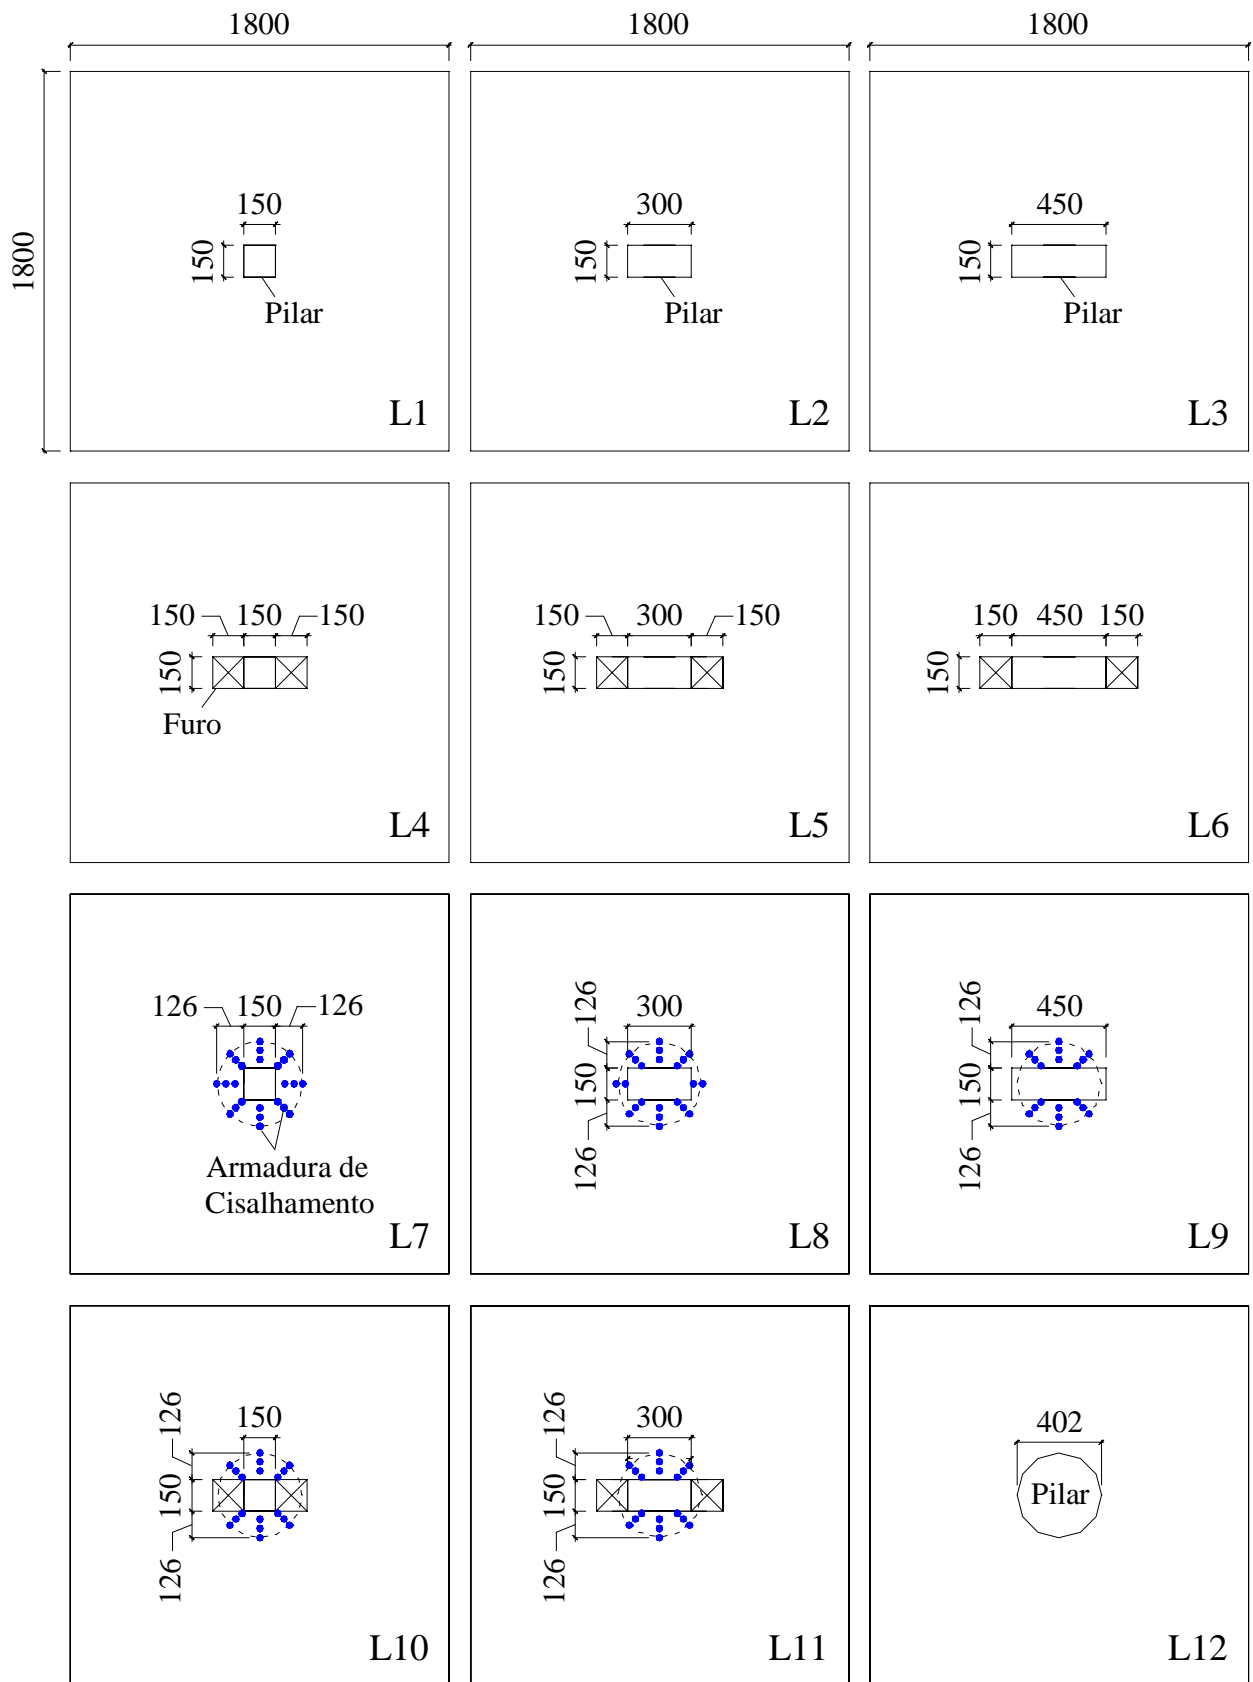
Características das lajes ensaiadas por SILVA (mm)
